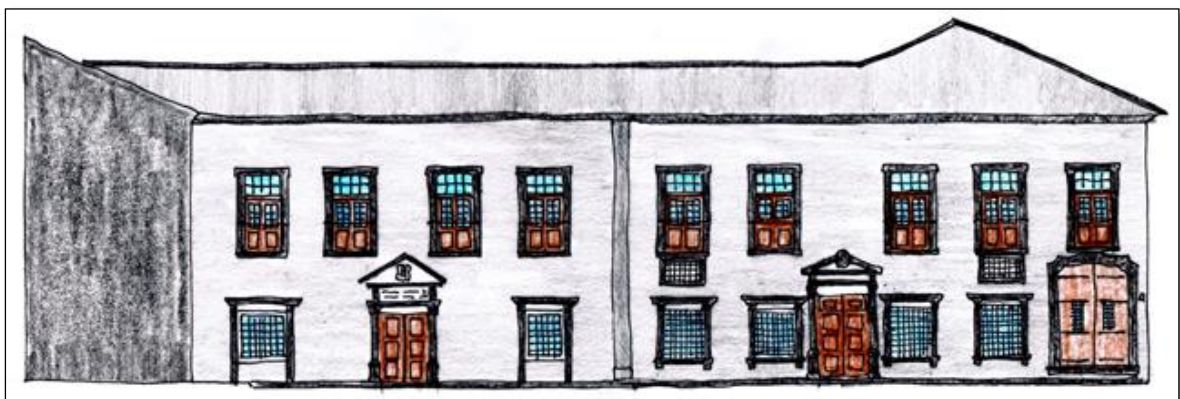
Fachada localizada a Este do LP. (Desenho do autor)
